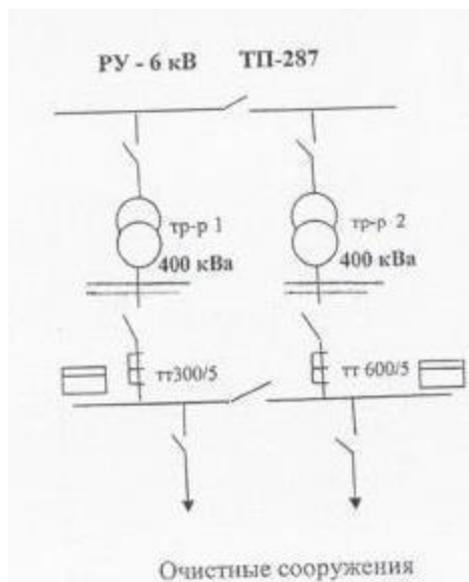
Схема электроснабжения КОС п.Новый Быт
